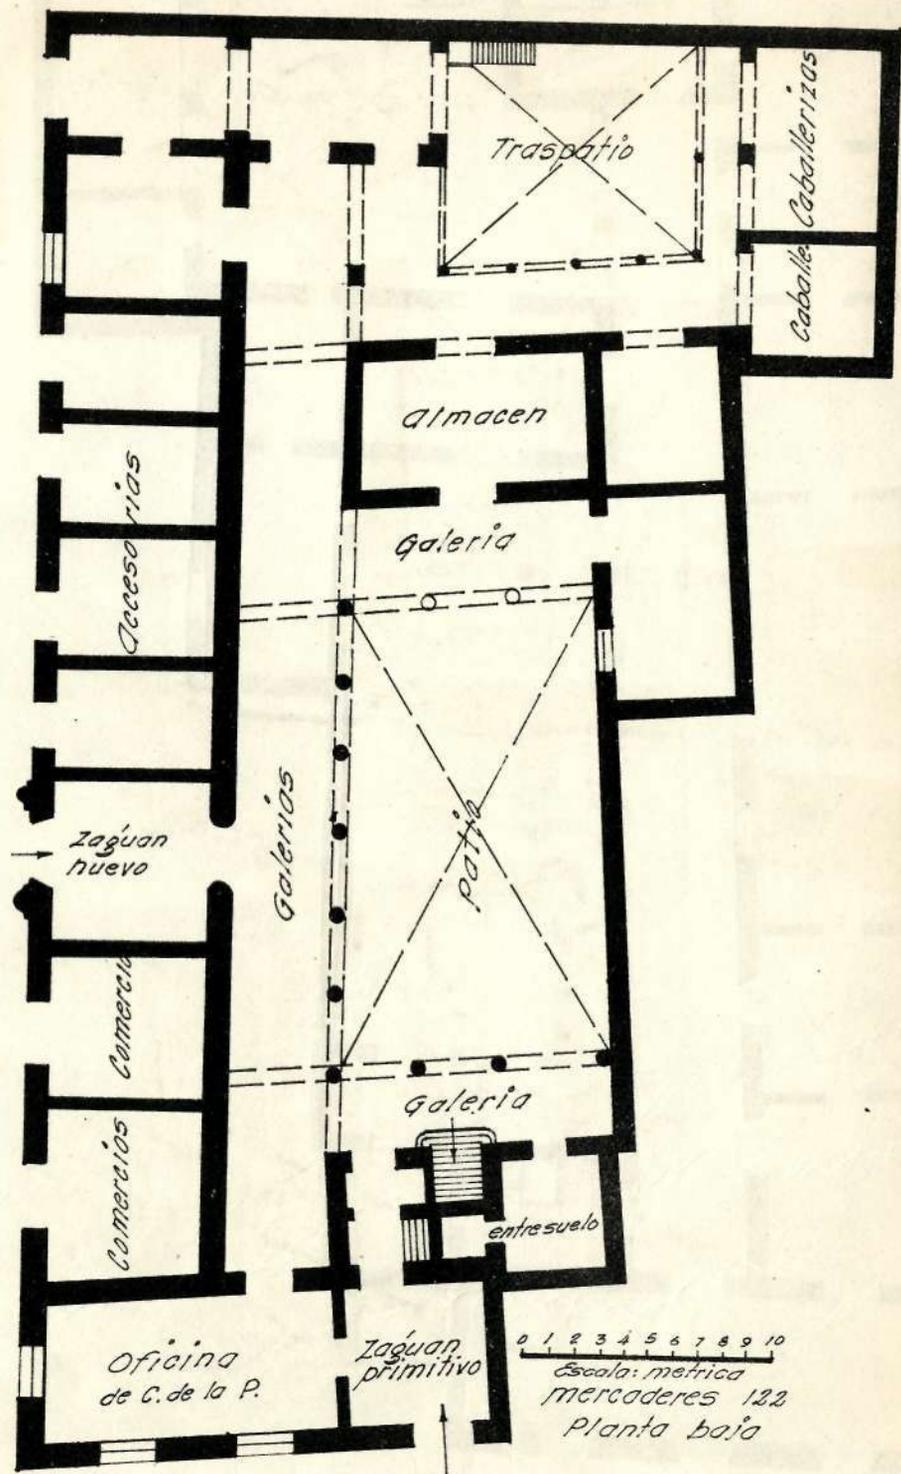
B Planta baja de la casa de Calvo de la Puerta.
